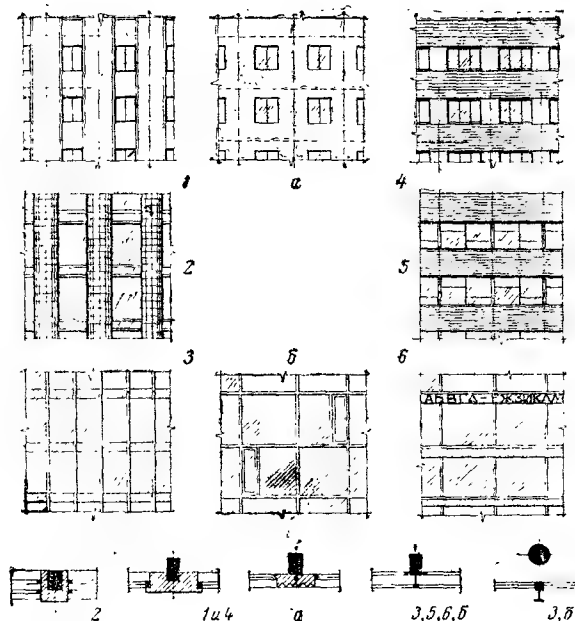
Варианты компоновки типовых участков фасадов многоэтажных зданий с навесными несущими стенами
